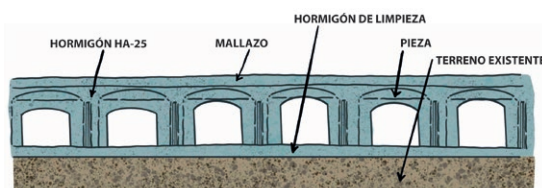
Sección constructiva de la solera ventilada. ¹³
